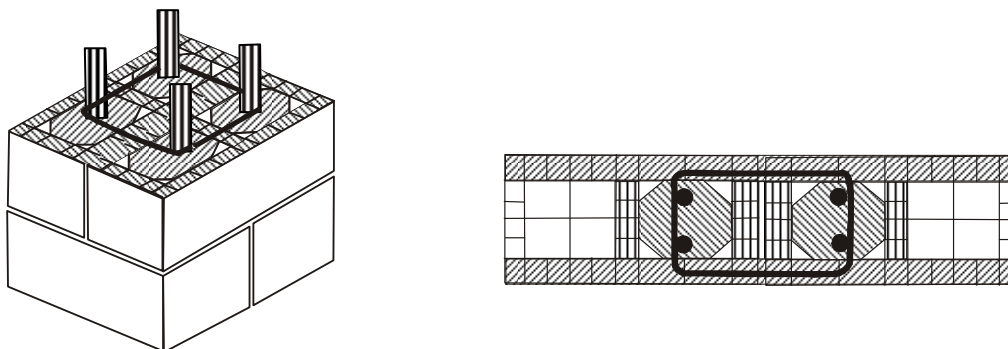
Columnas, aspectos constructivos.
